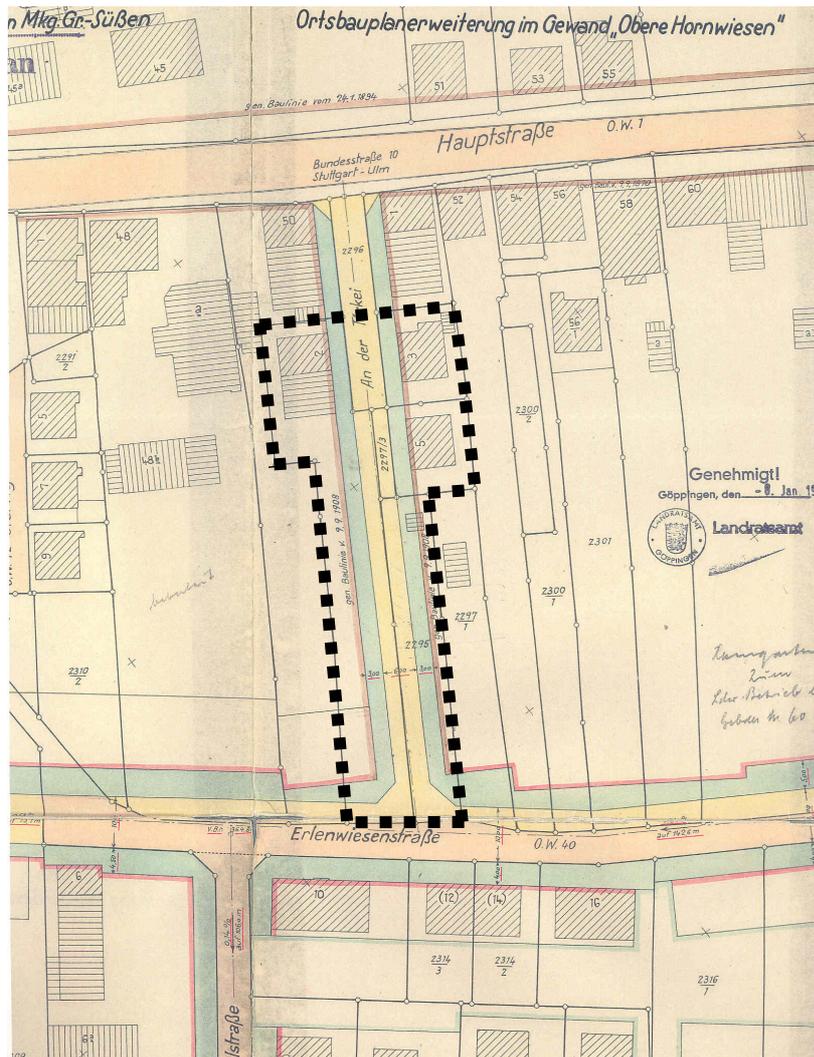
rechtsverbindlicher Baulinienplan aus dem Jahr 1958
